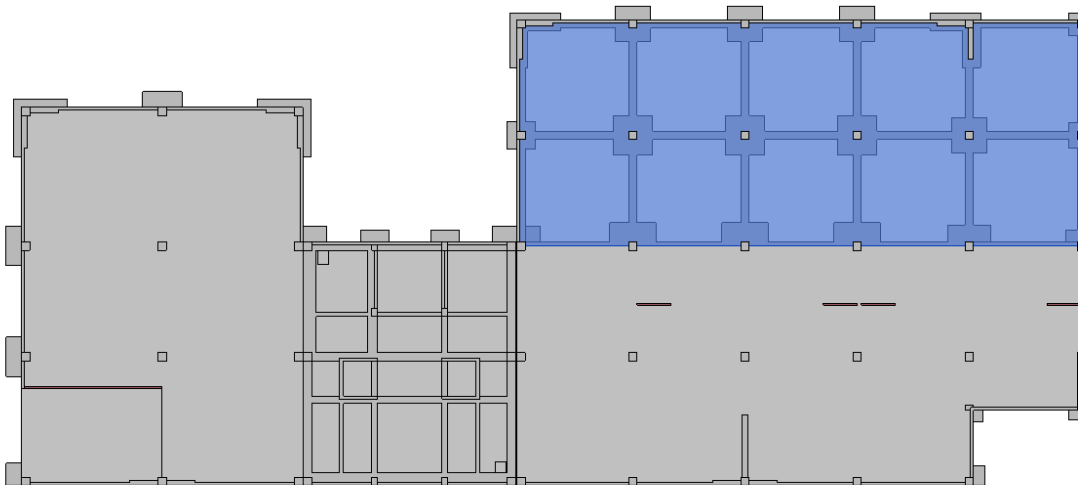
Plano en planta de contrapiso (Revit). Fuente: Grupo de investigacion Geomatica
